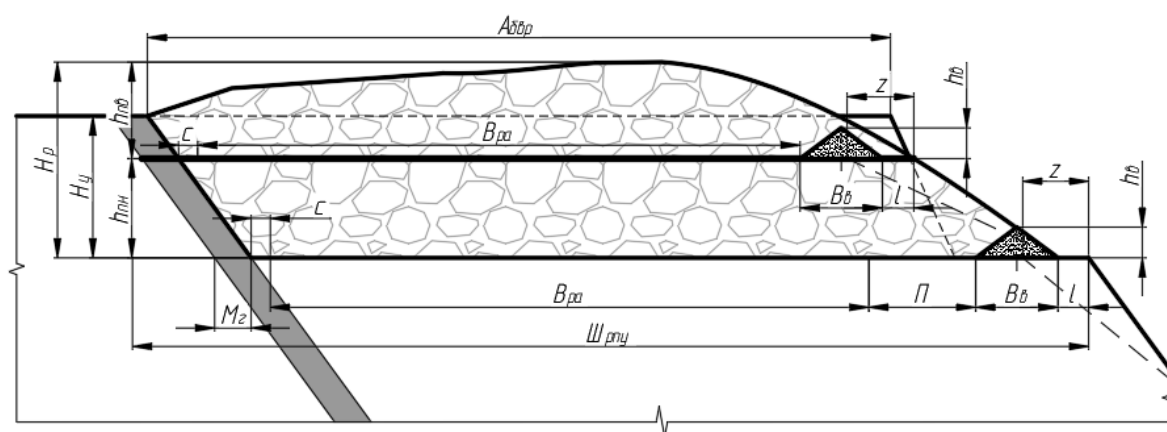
Схема к определению ширины рабочей площадки при отработке угольного пласта торцевым забоем
